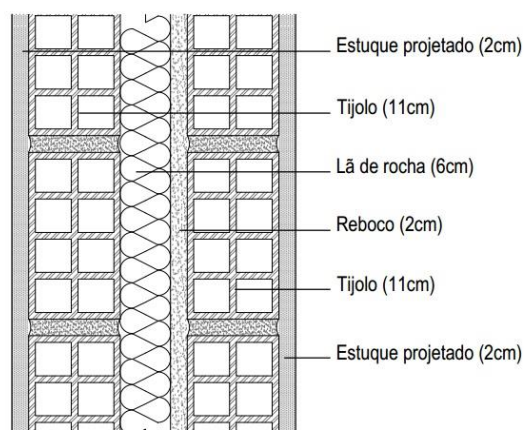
Pormenor da parede divisória dos apartamentos e das zonas de circulação
